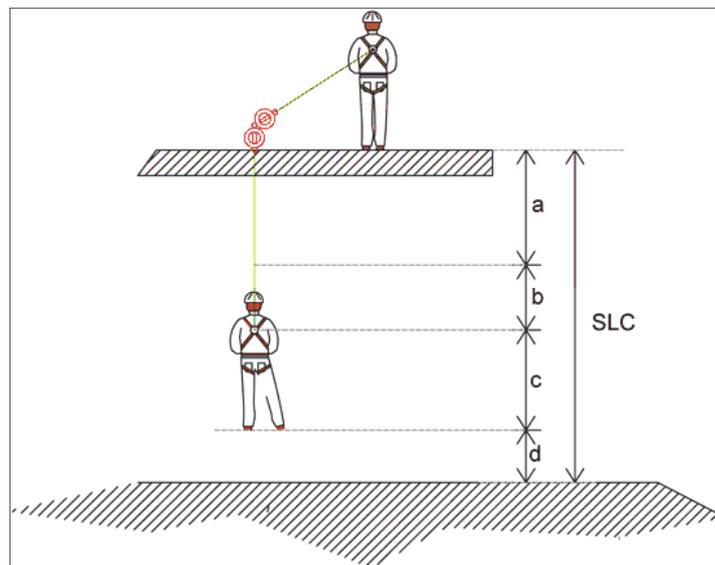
Spazio libero di caduta con punto singolo di ancoraggio e dispositivo anticaduta retrattile
